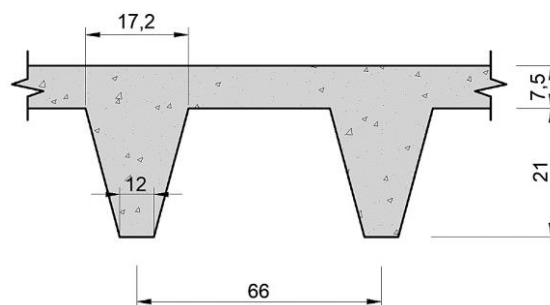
Projeto A1 - Seção da laje nervurada.
